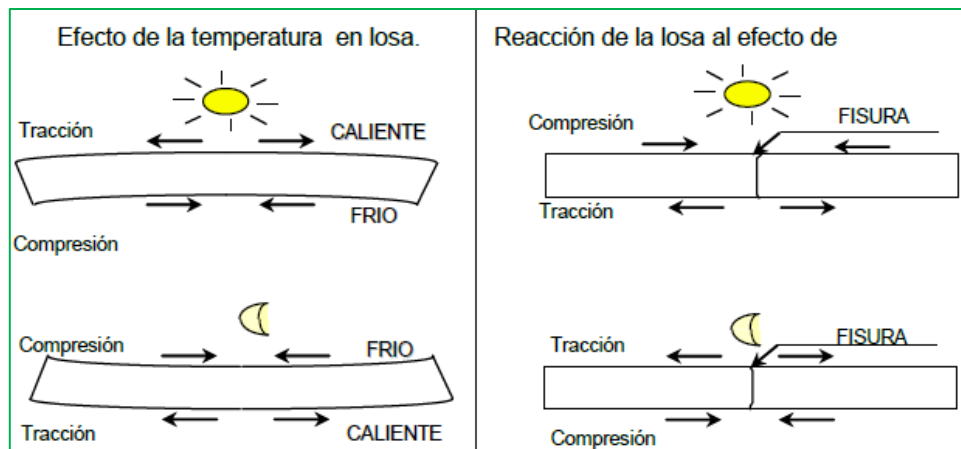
B) Vista de sección de losa en comportamiento alabeo diurno y nocturno. Fuente: Pavimentos de Concreto para carreteras. (Ref. Bibliografía 5)
